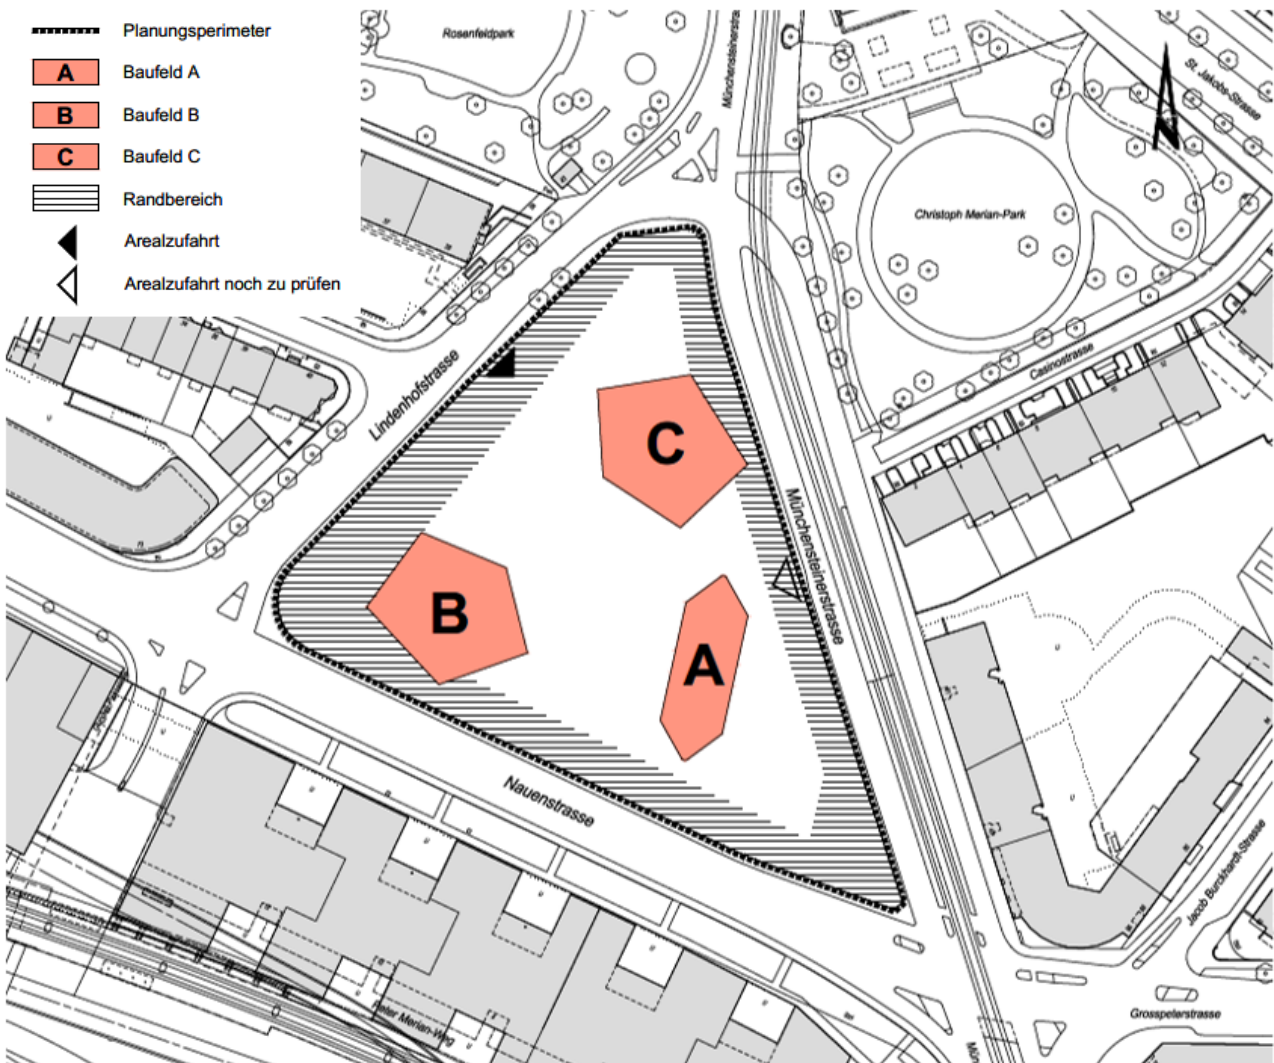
Neuer Bebauungsplan. Plan Nr. 14'379 vom 08.07.2022 (ohne Masstab, genordet)
